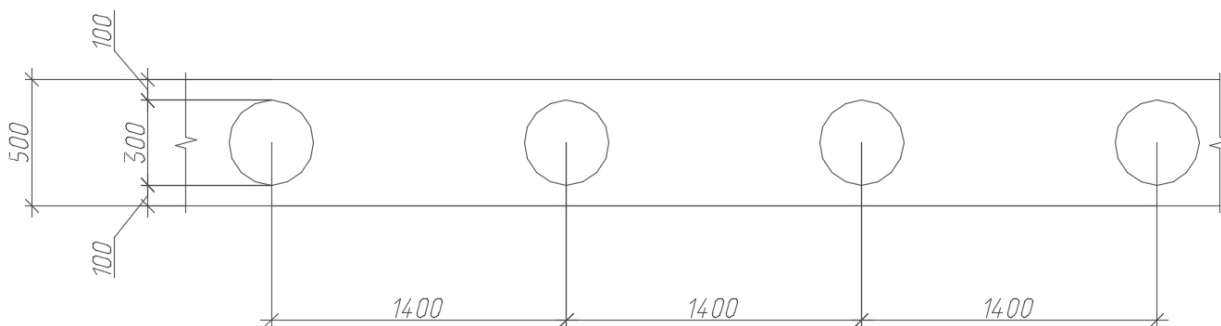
схема расположения свай в рядовом фундаменте
